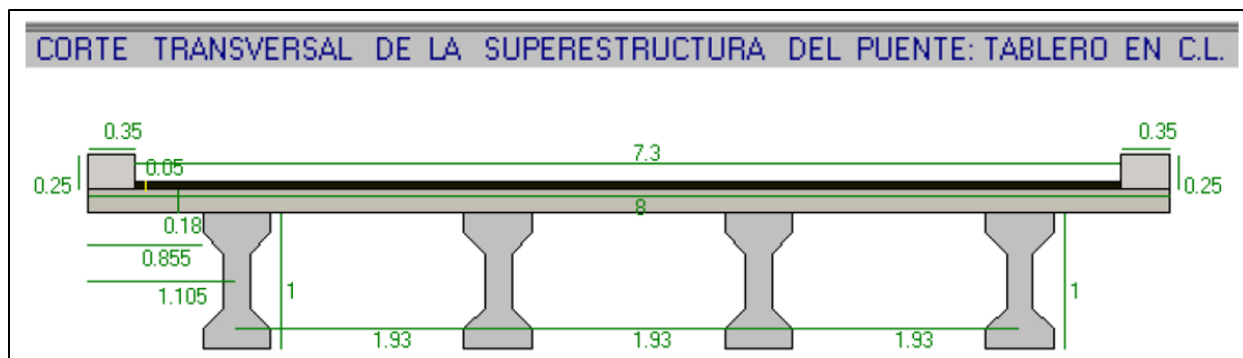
Esquema de la superestructura del puente de concreto postensado.
